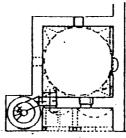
مسقط أفقى لمسجد صرجالى بقونية (عن : Aslanapa) .
